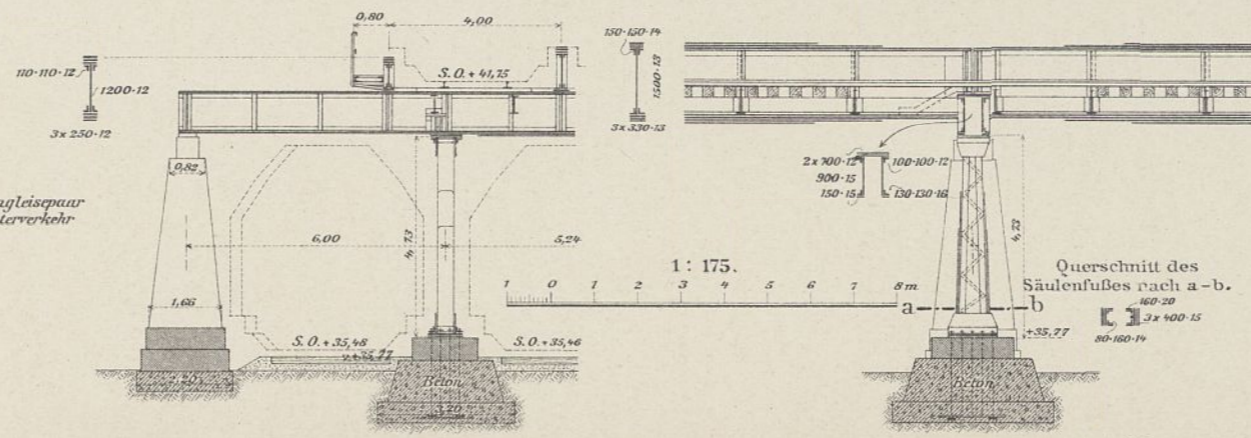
Schnitt nach a-b des Grundrisses.
